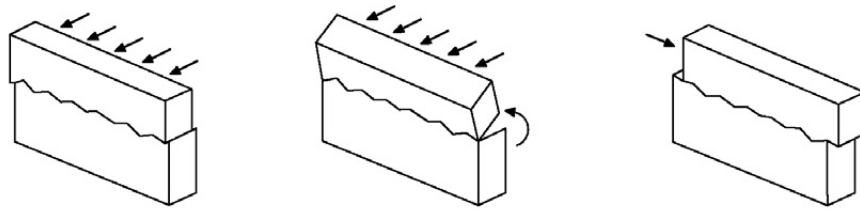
Grietas por movimientos horizontales.
